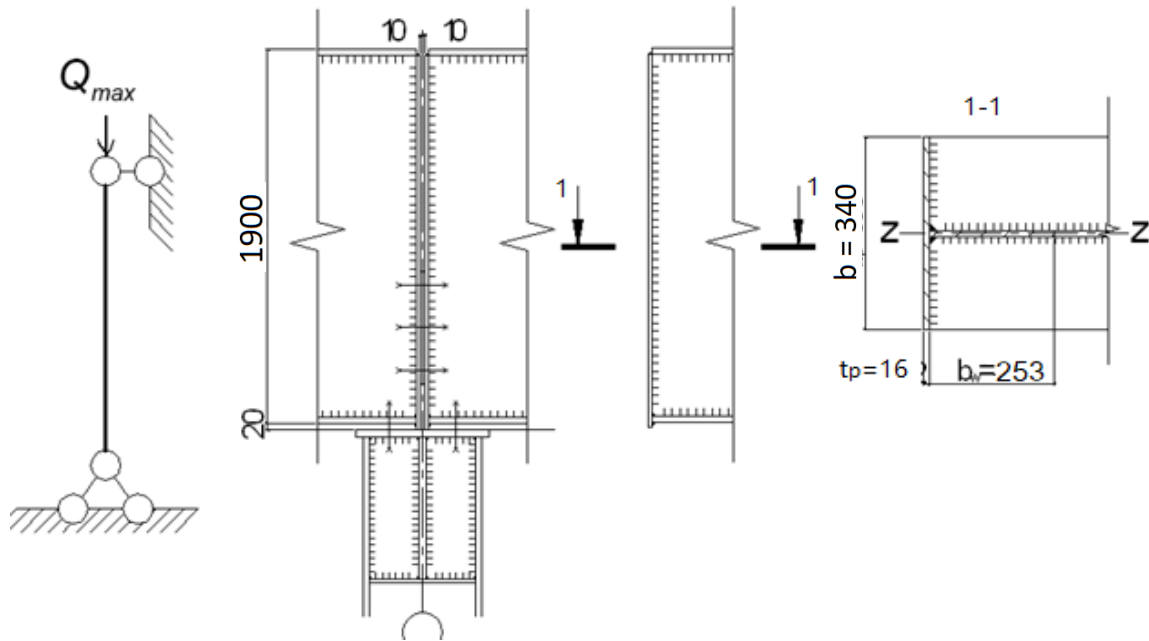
Расчетная и конструктивная схемы на устойчивость опорного участка главной балки
